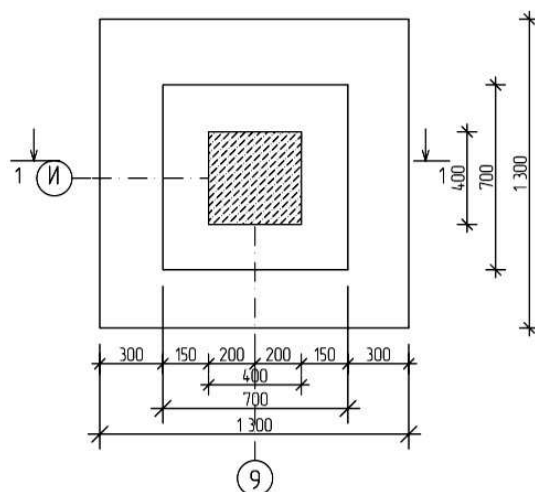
Схема столбчатого фундамента Ф-1, вид сверху.
